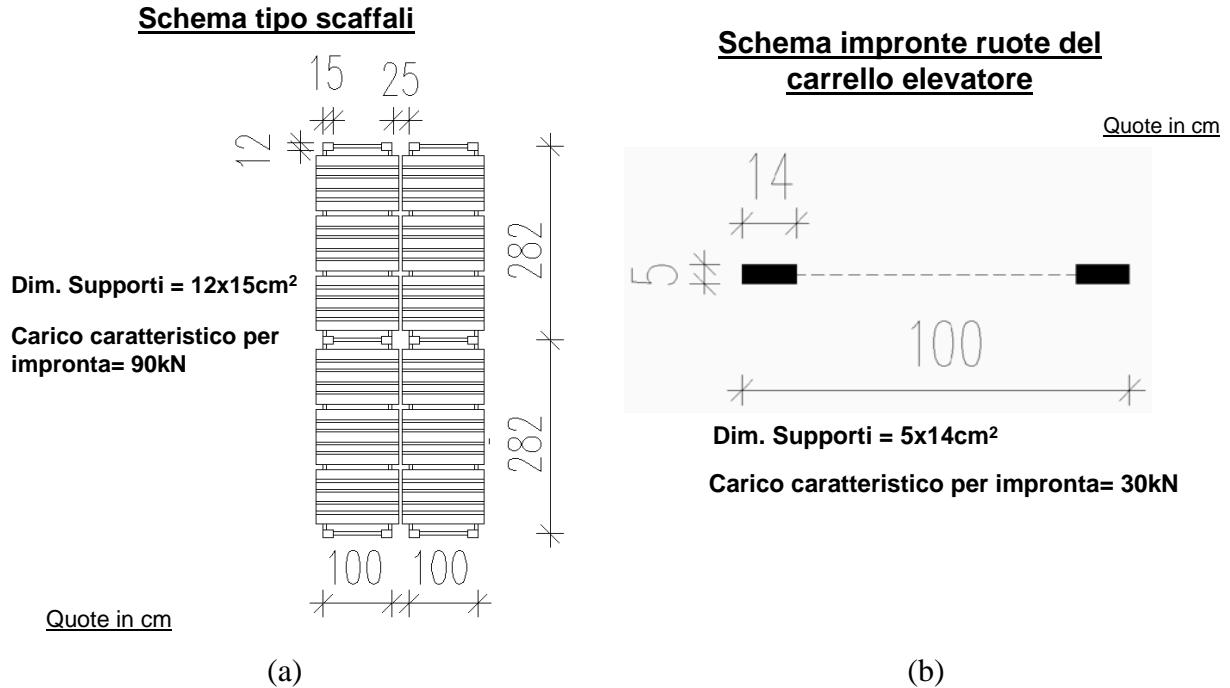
Schematizzazione dei carichi applicati alla pavimentazione: supporti degli scaffali (a); singolo asse di carico del carrello elevatore (b).
